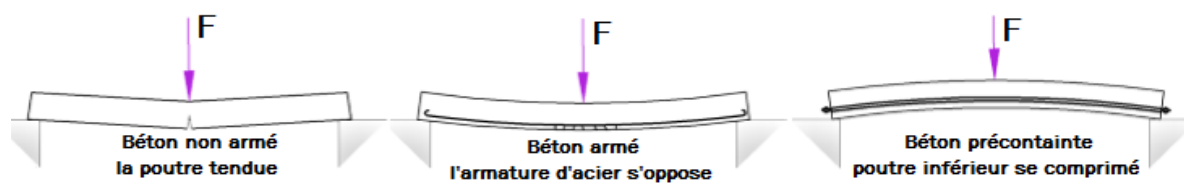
LE PRINCIPE DU BETON PRECONTRAIT.
